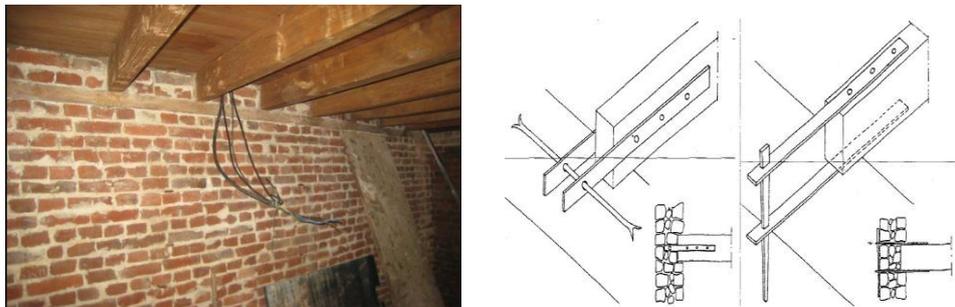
Plancher flexible bien connecté (COIG87).
